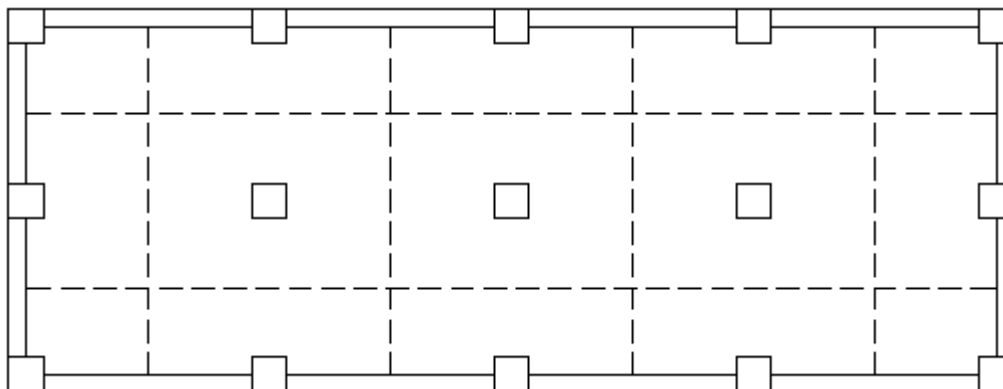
Planta representativa de um ensoleiramento geral [adaptado de 6]
